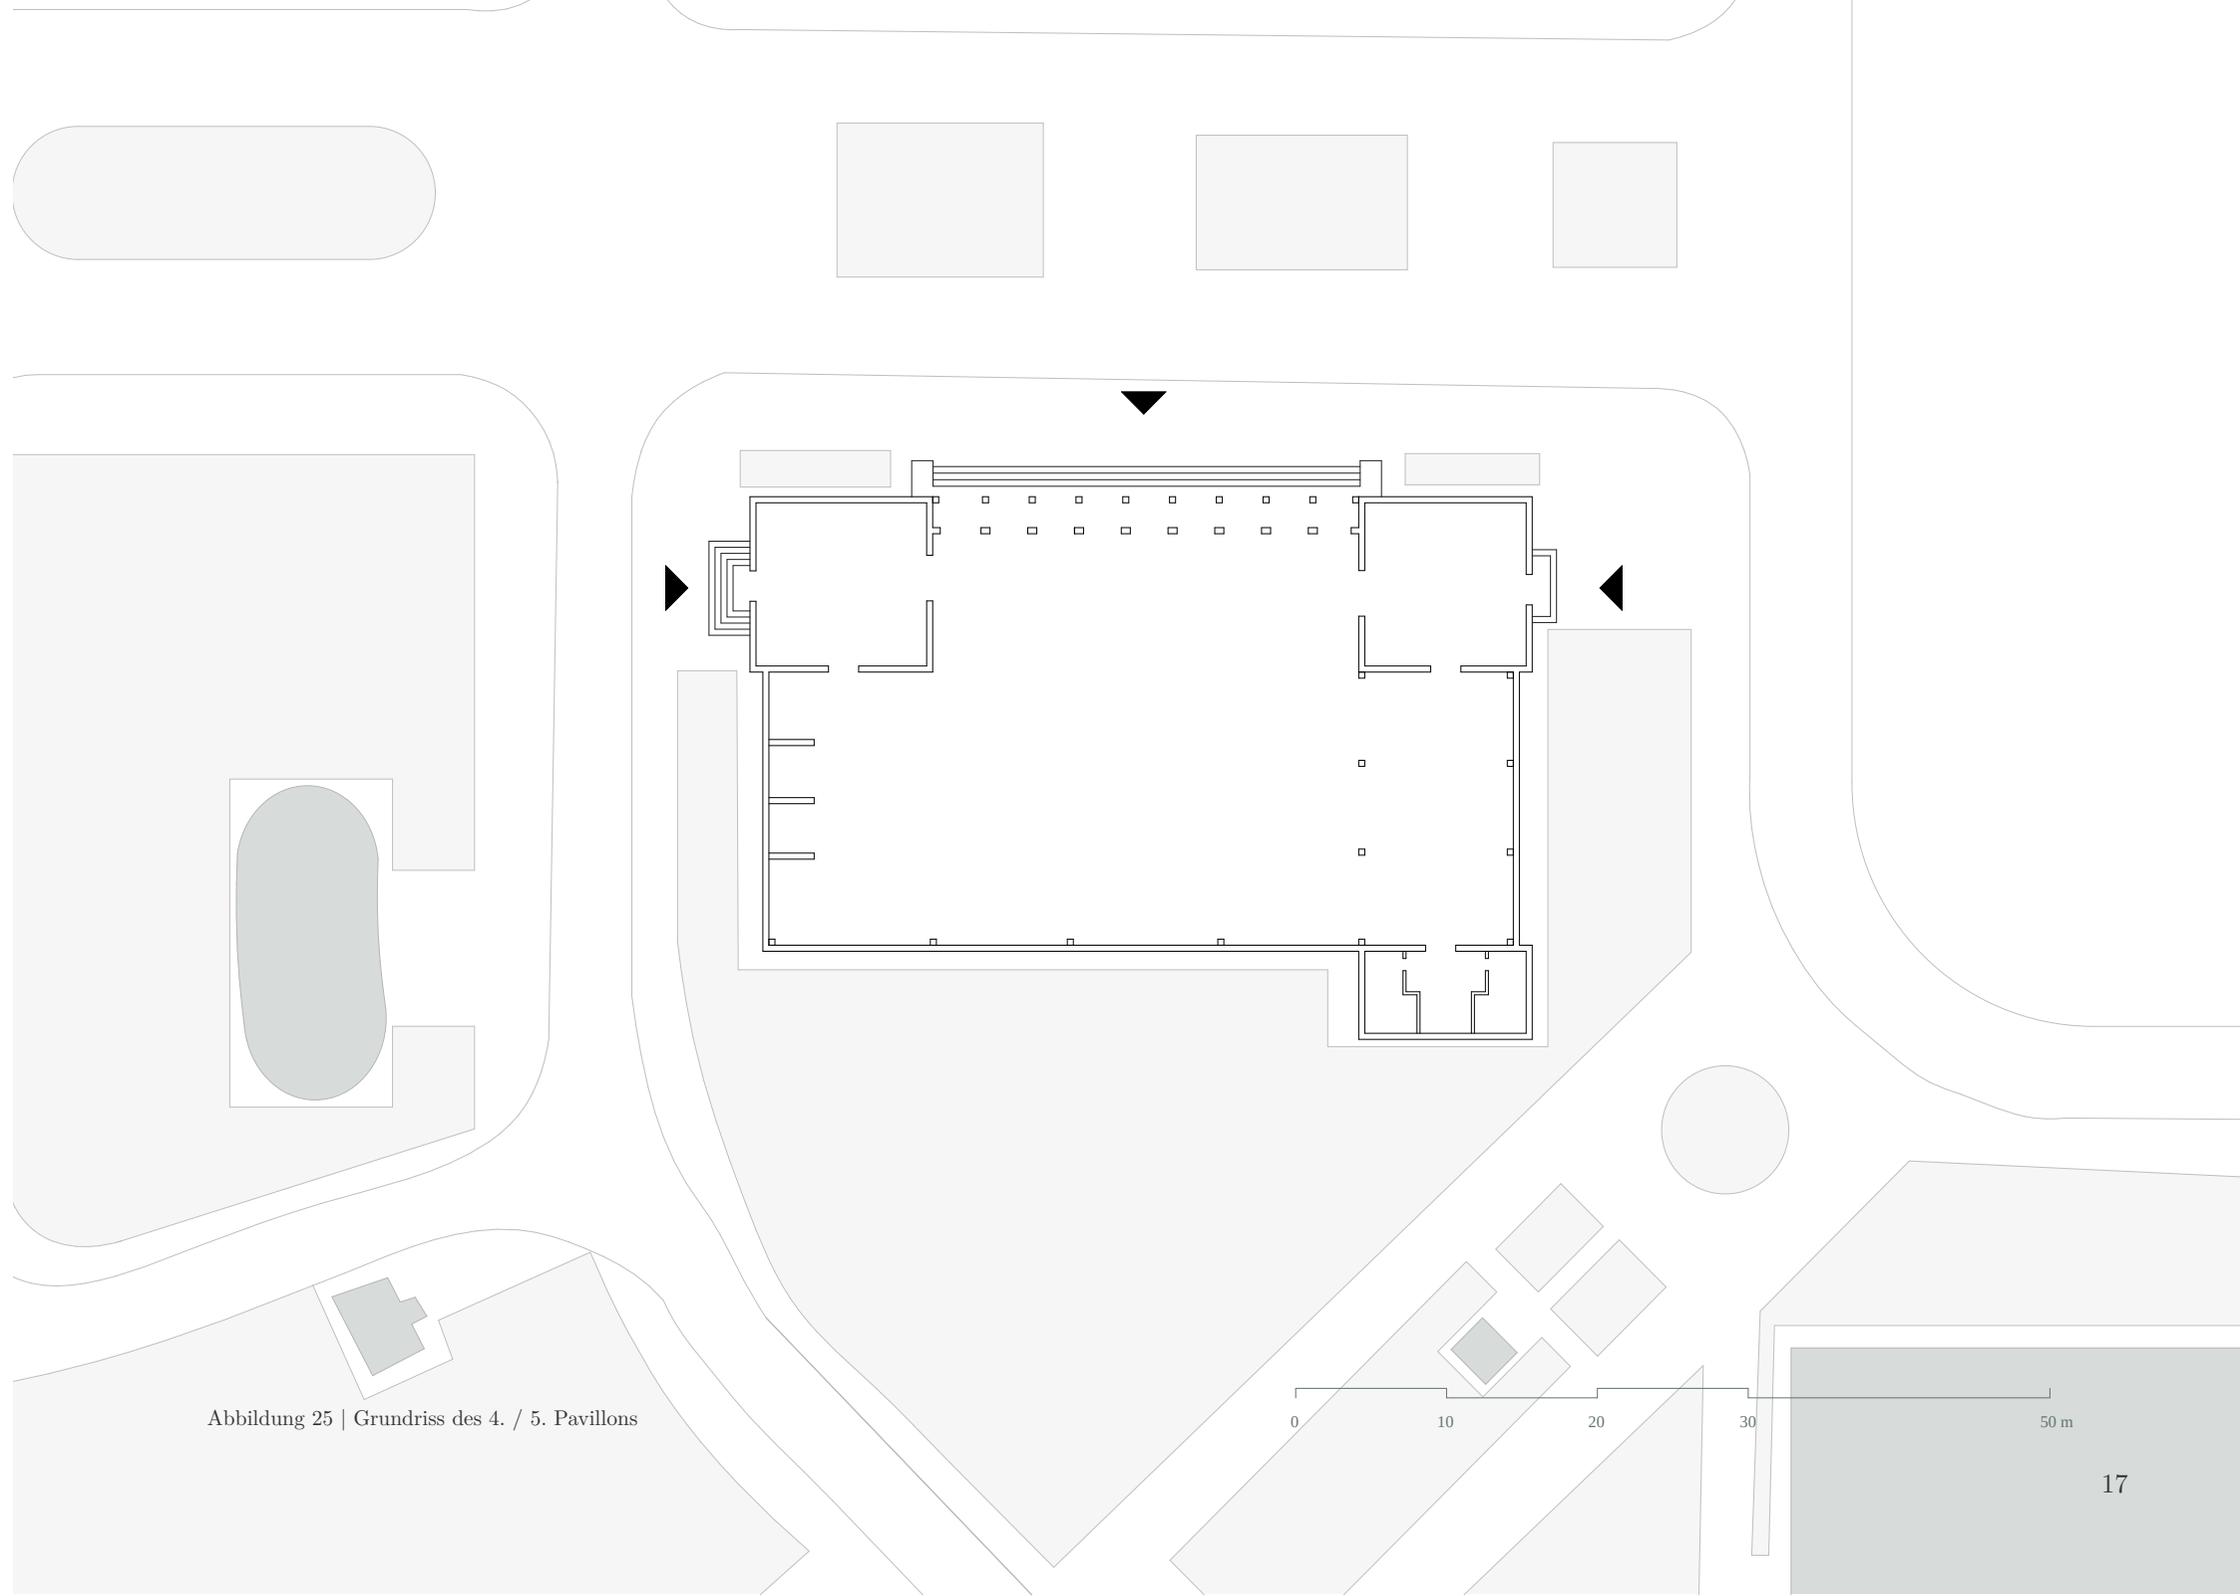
| Grundriss des 4. / 5. Pavillons
